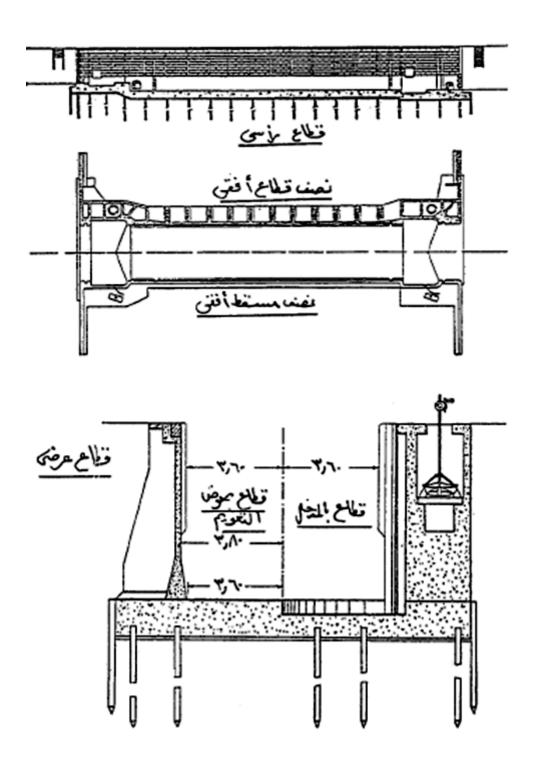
قطاع في هويس براندولو، إيطاليا
